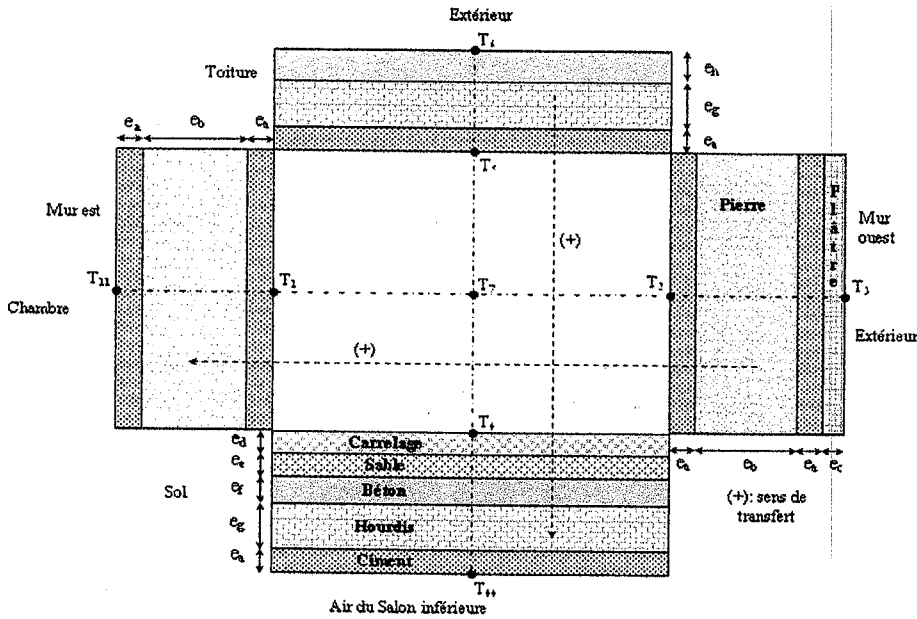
Coupe longitudinale et identification des différentes couches (+): sens de transfert
